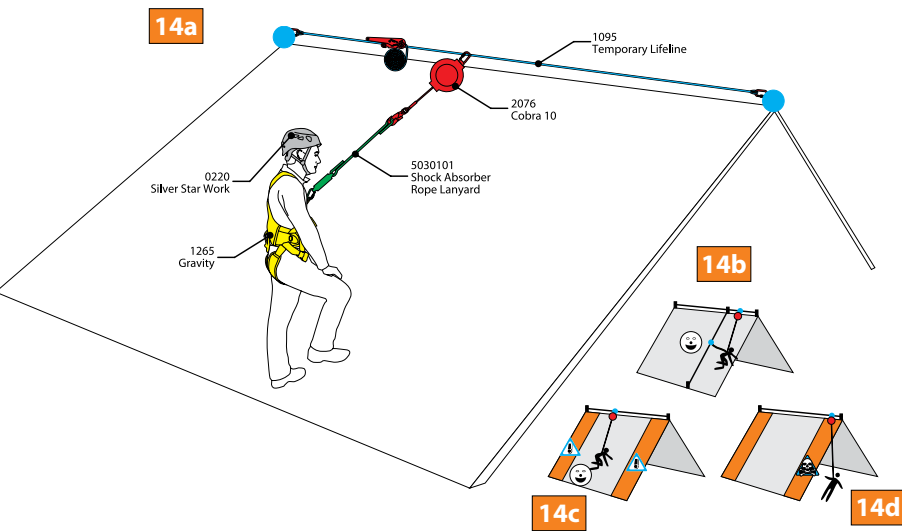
Правильное использование инерционных страховочных устройств обеспечивает оптимальную свободу безопасного передвижения на кровлях/террасах. Строп с амортизатором должен соединять привязь работника и инерционное страховочное устройство, сертифицированное как предотвращающее проскальзывание троса в случае падения с края кровли/террасы (рис. 14а). Во время работы у боковых краев существует также риск падения с последующим эффектом маятника (рис. 14b-d), в этом случае инерционное страховочное устройство должно быть продублировано вертикальной анкерной линией со стропом и амортизатором рывка (рис.14b) или надёжно прикрепленным анкерным точкам на краях.
